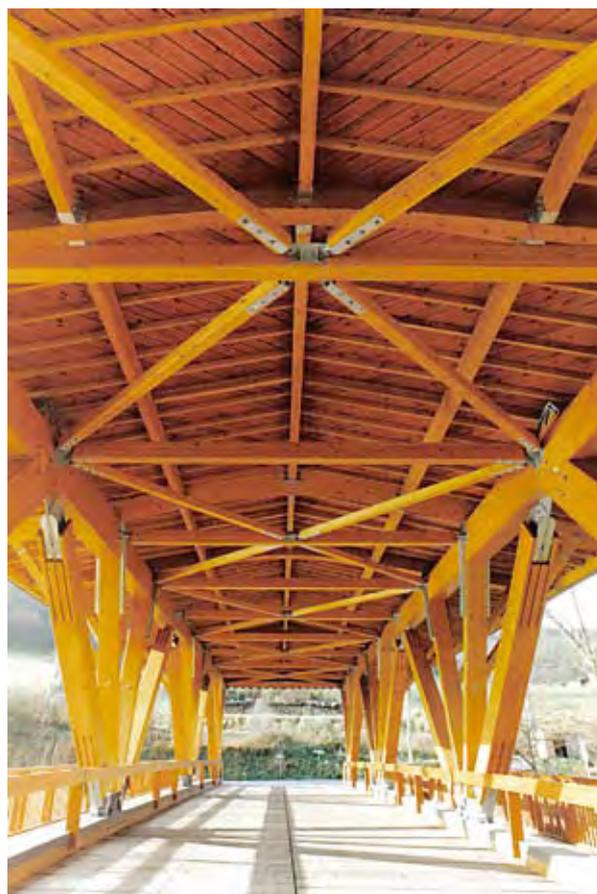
pont sur la Dore (vue intérieure) – Source : Brumaire
